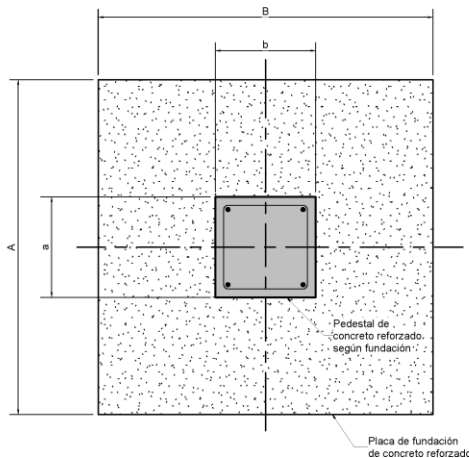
Detalle típico de placa aislada (vista en planta) - Elaboración propia, 2024
